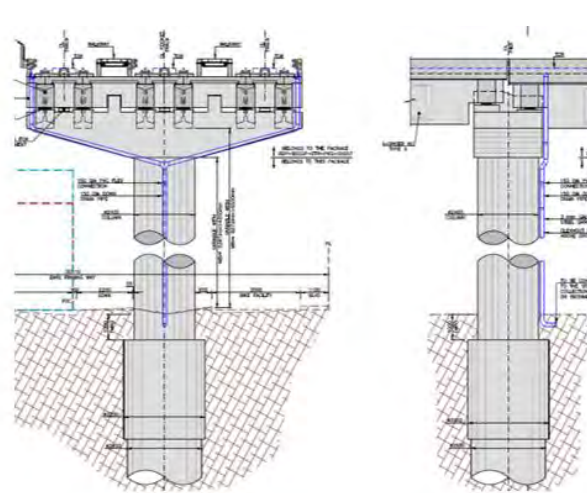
Sección del tablero y pila con apoyos de neopreno zunchado para apoyo de las vigas.
